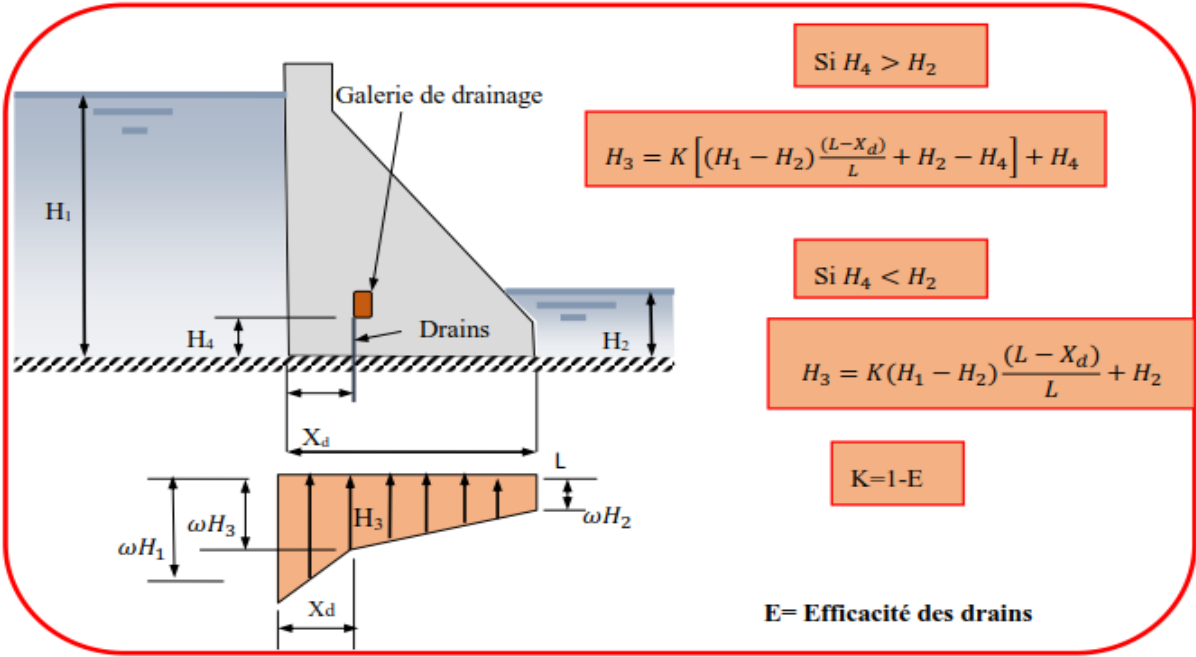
Sans fissuration le cas où la hauteur du drain supérieur à la hauteur d'eau aval ($H_4 > H_2$) (Schleiss and Pougatsch, 2011)
